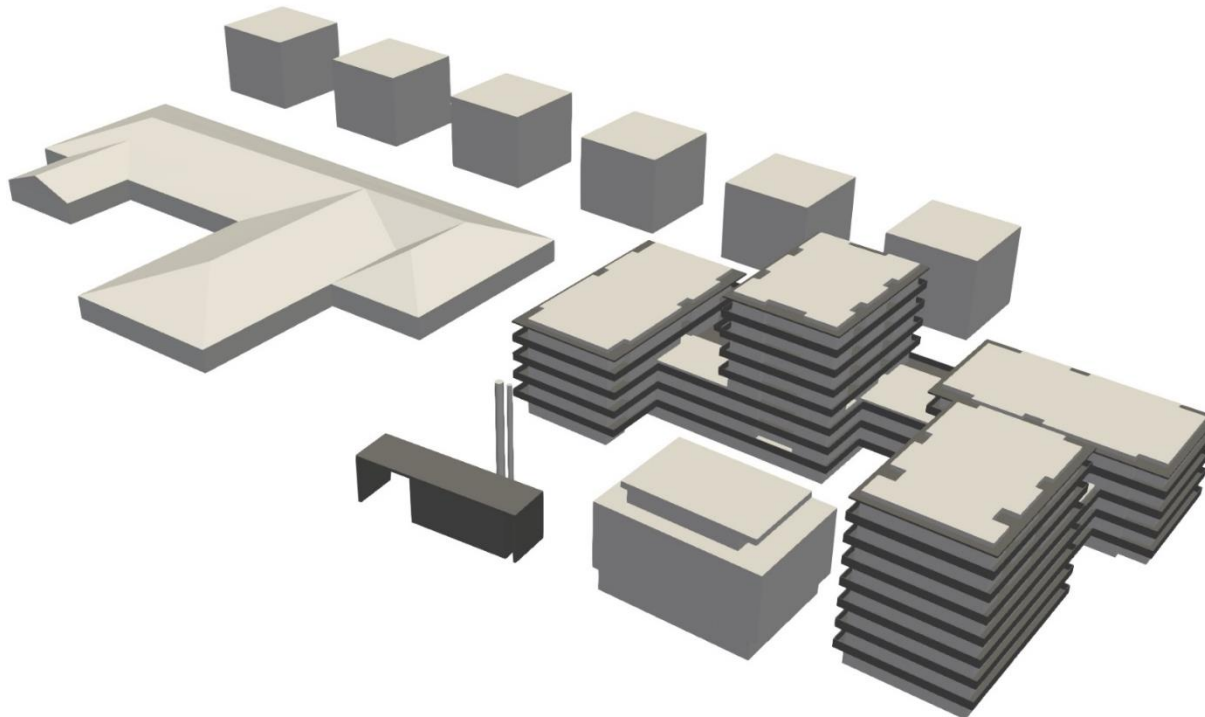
3D-Modell der geplanten Bebauung an der Römerstraße 67 mit bereits bestehendem Blockheizkraftwerk und Nachbarbebauung
